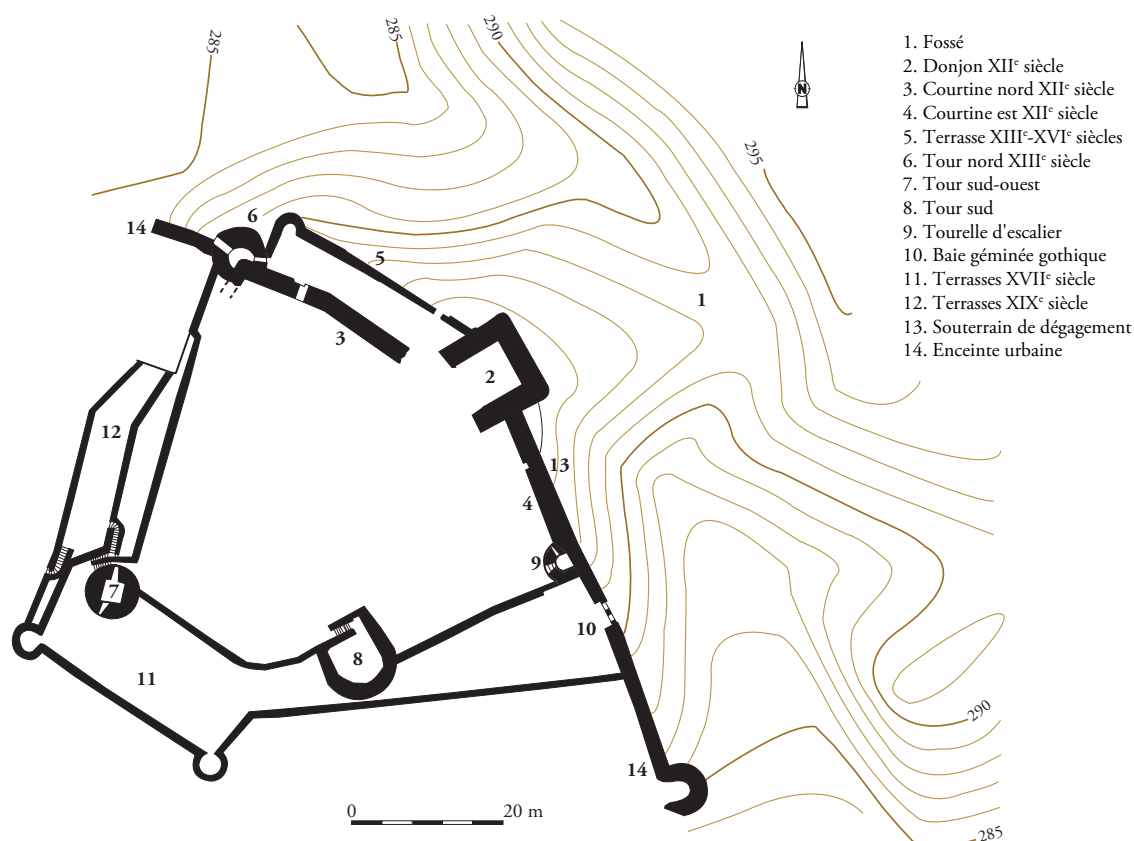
Plan des vestiges du château (relevé Gérard Giuliano et coll. ; DAO Cédric Moulis).
